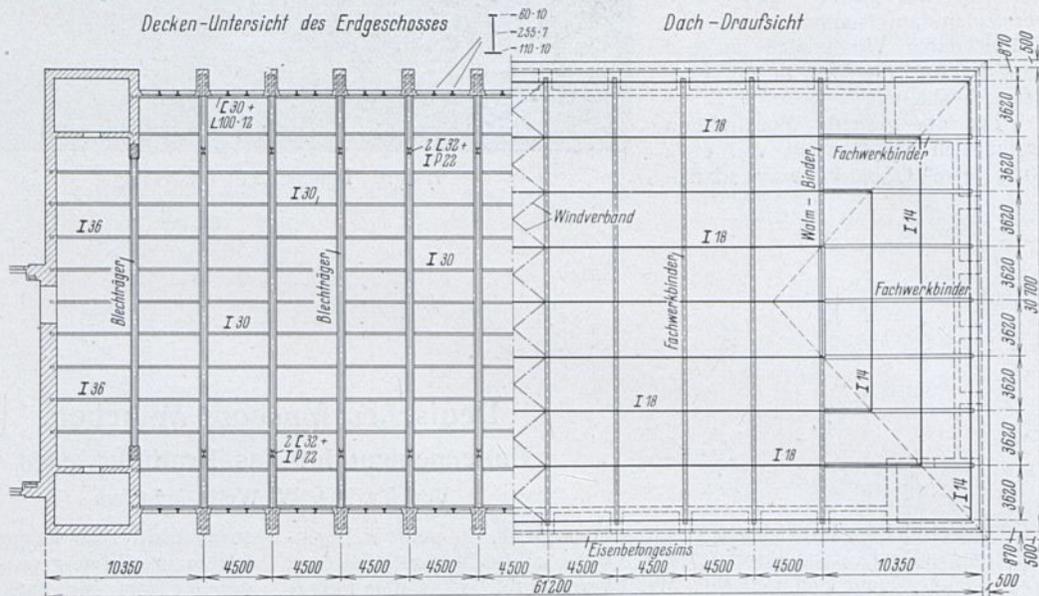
Dachdraufsicht und Deckenuntersicht des Erdgeschosses.
